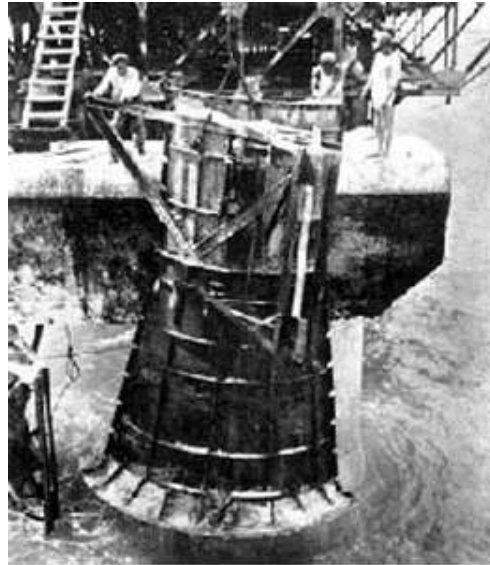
Construcción de una de las pilas de concreto masivo (Christensen, 1954)
